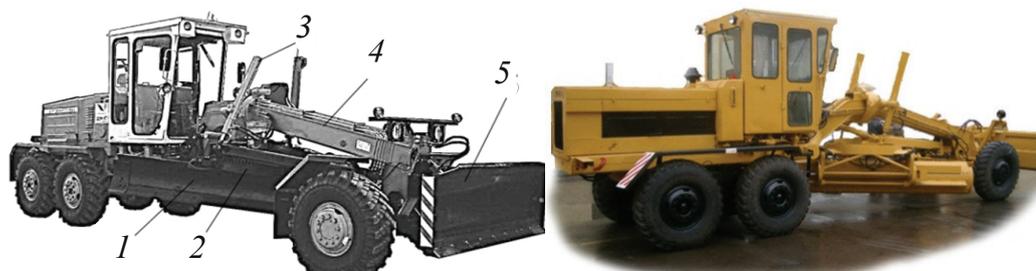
Автогрейдер ДЗ-99: 1 – отвал грейдера; 2 – поворотный круг; 3 – гидроцилиндр подъема-опускания рабочего органа; 4 – тяговая хребтовая рама; 5 – отвал-толкатель
